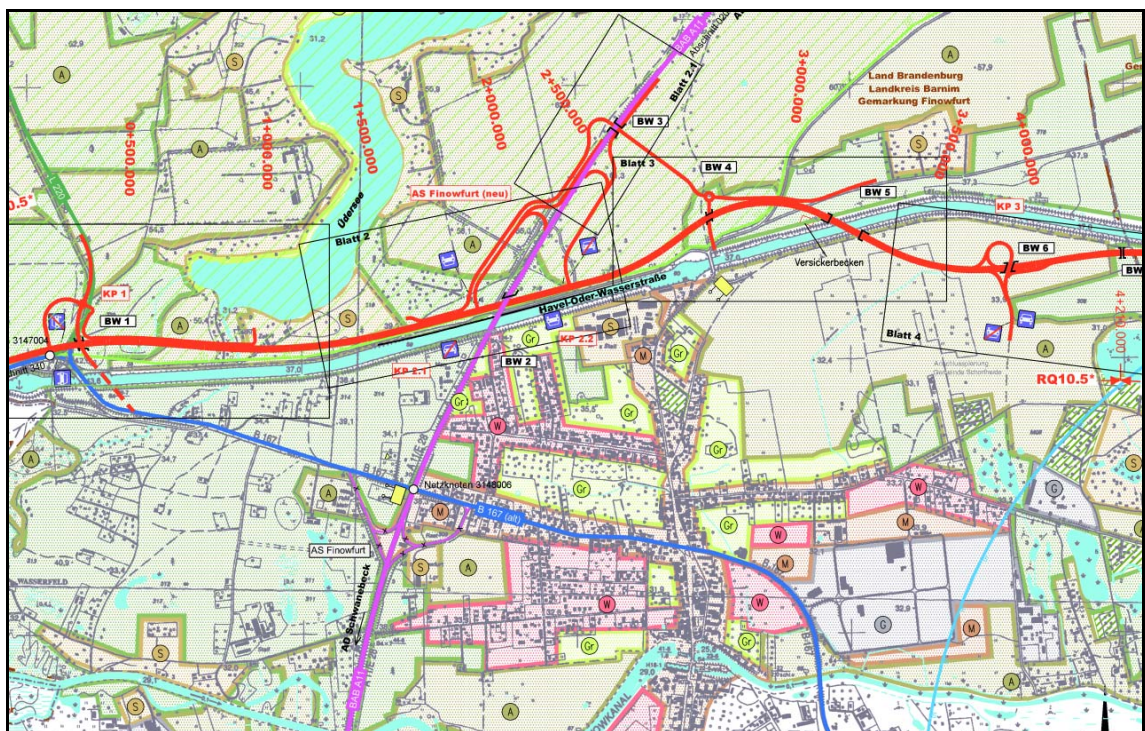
Übersichtslageplan Ortsumgehung B 167n im Bereich der Ortslage Finowfurt
